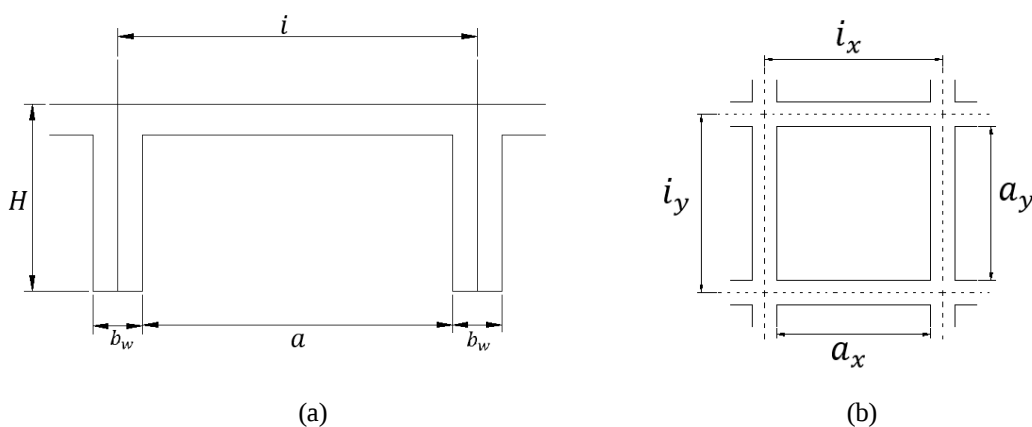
Peso próprio calculado para laje nervurada. (a) seção transversal e (b) em planta.
